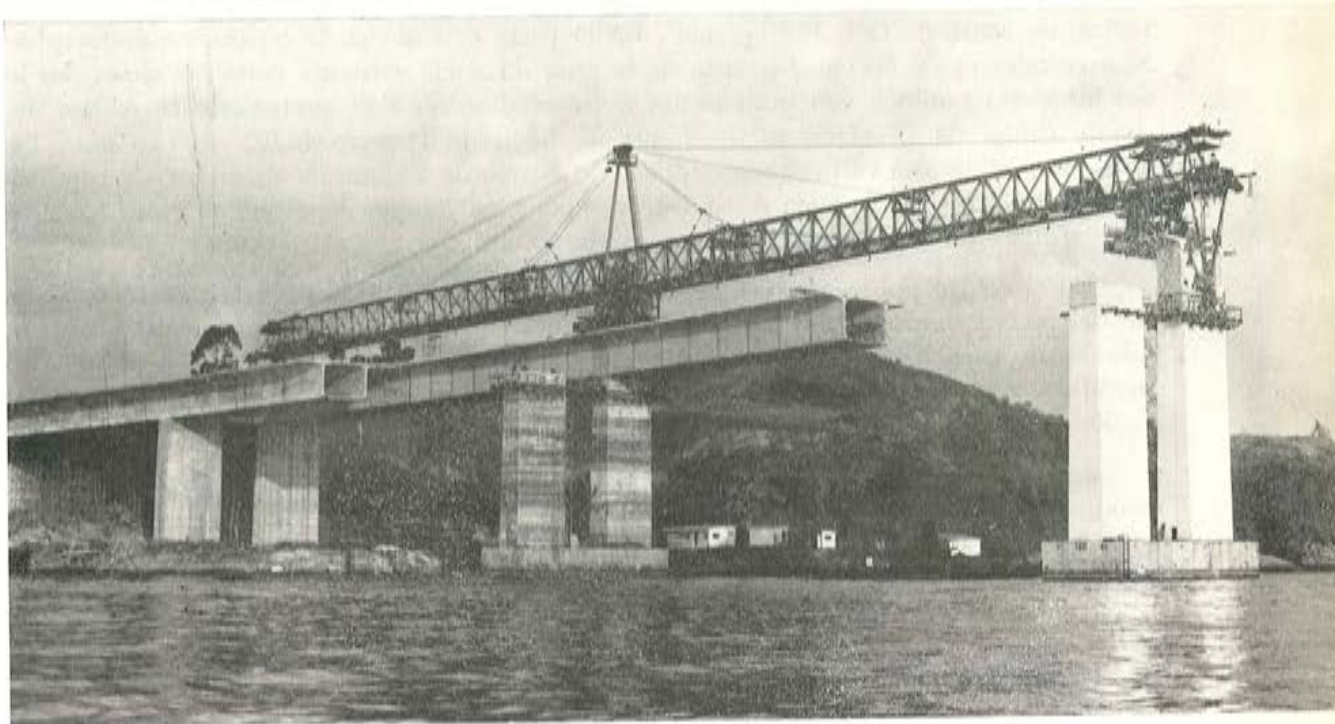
Vista del estribo P123 y de las pilas P122 y P121.
